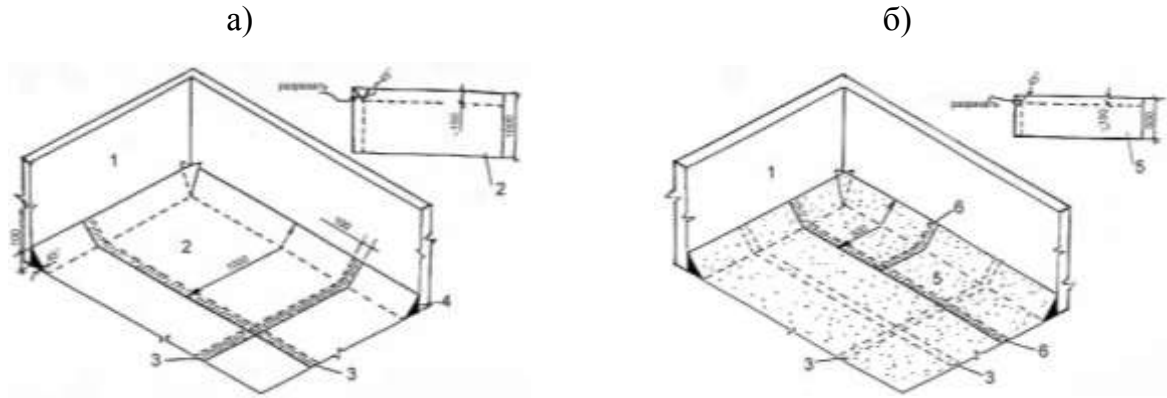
Раскладка и раскрой полотнищ наплавляемого рулонного материала (а – нижнего слоя, б – верхнего слоя) при устройстве основного кровельного ковра в углу парапета
